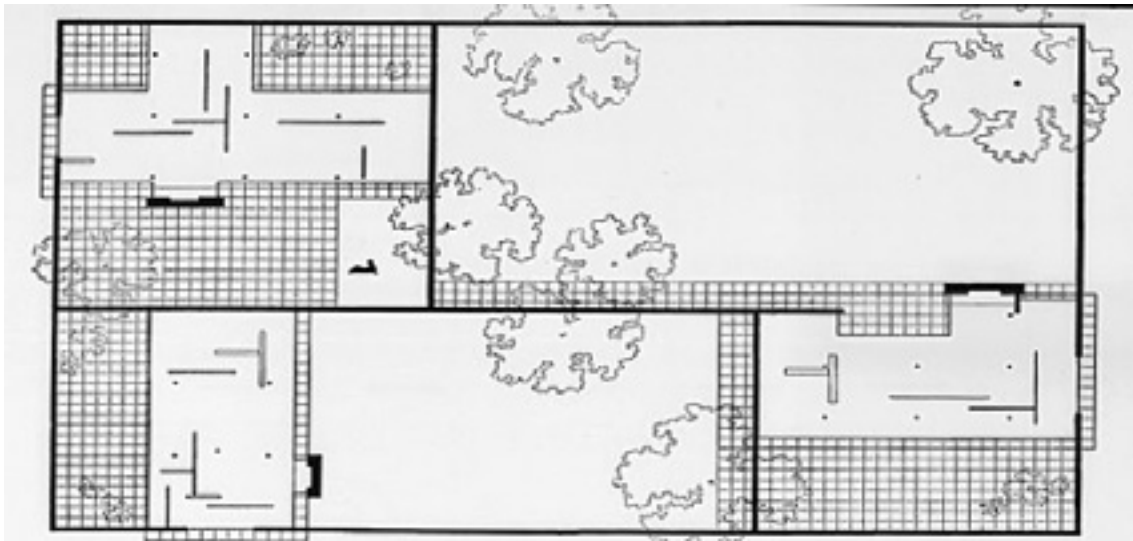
Planta casa pátio, Mies Van Der Rohe.
